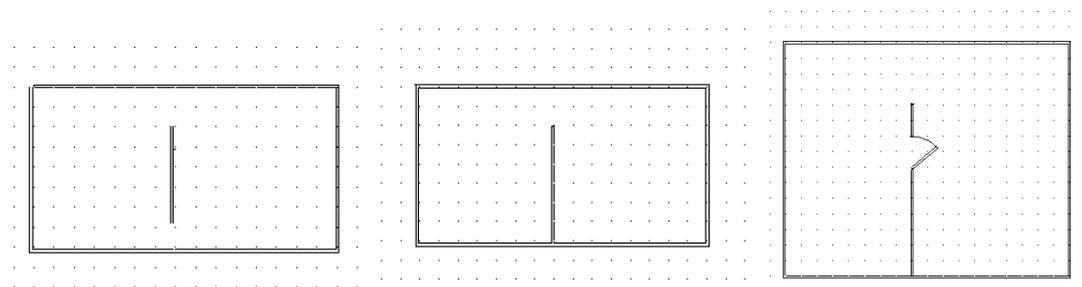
Les étapes de création d'un mur enveloppe et d'un mur perpendiculaire à l'aide d'une grille de fond
